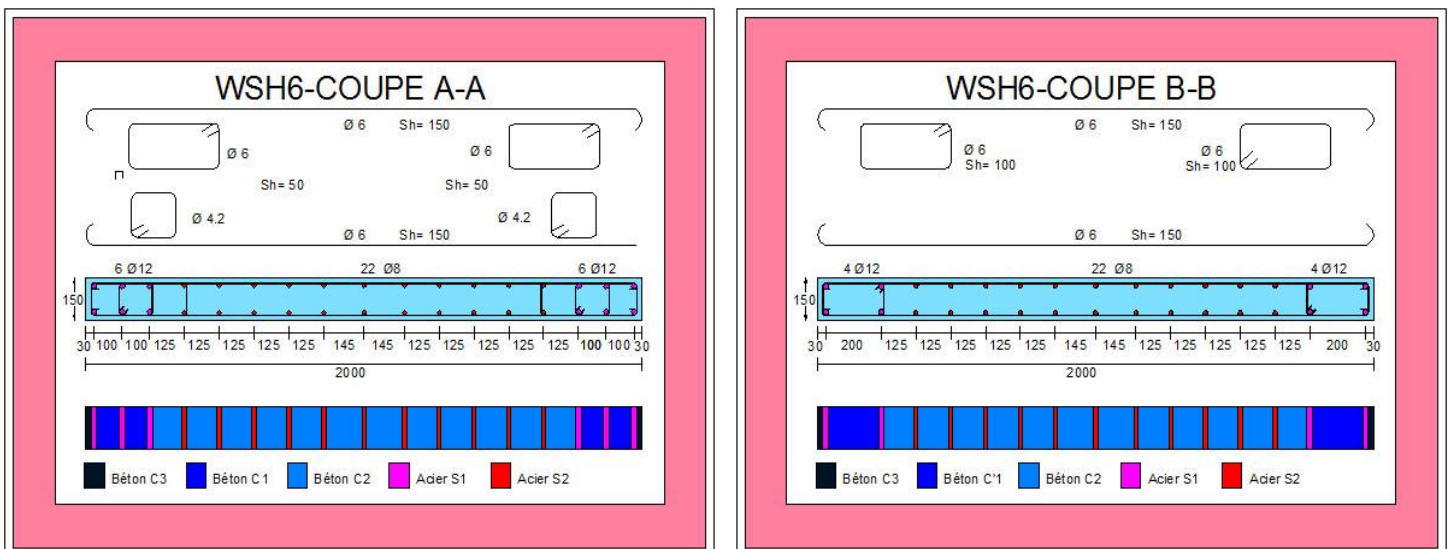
Ferrailage et modélisation multicouche de la section en béton armé, dimensions (mm) : WSH6, Coupe A-A et B-B
